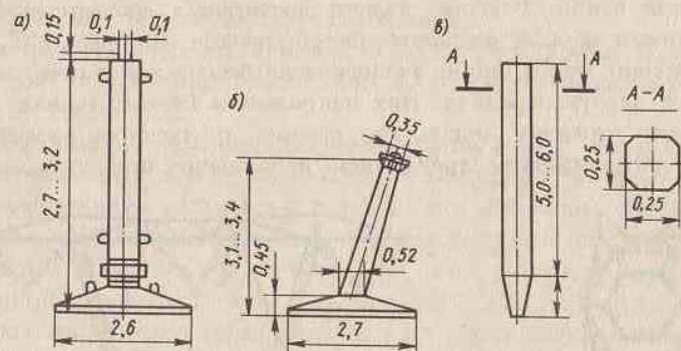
Железобетонные фундаменты (а - для промежуточных, б - для анкерных угловых) и сваи (в) для металлических опор
